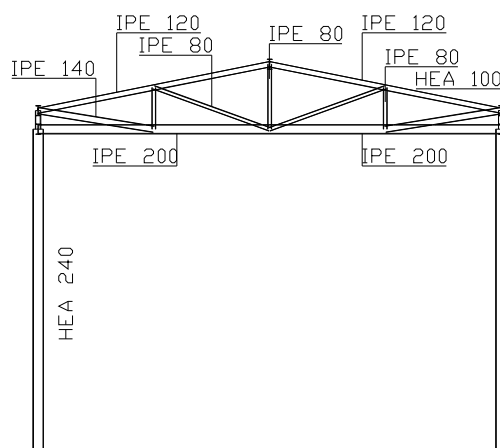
Pórtico com pilar de alma cheia, viga em treliça, vão de 10.00m, pilar em perfil com secção transversal HEA, viga em perfil com secção transversal IPE.
